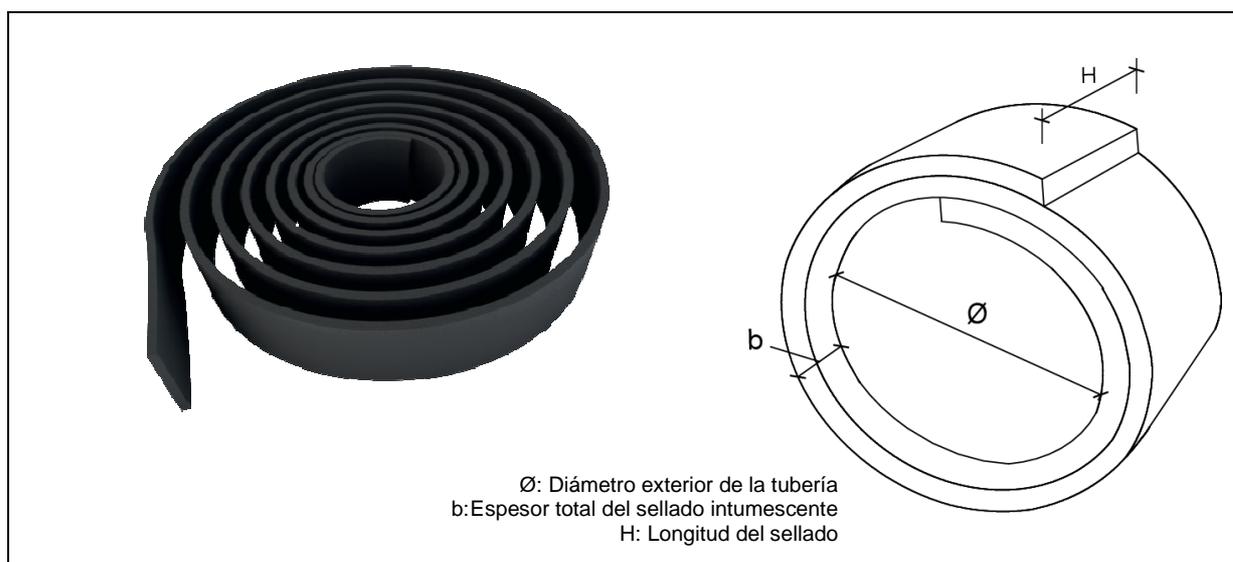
Vista general del rollo de AF SLEEVE y dimensiones del sellado instalado.
